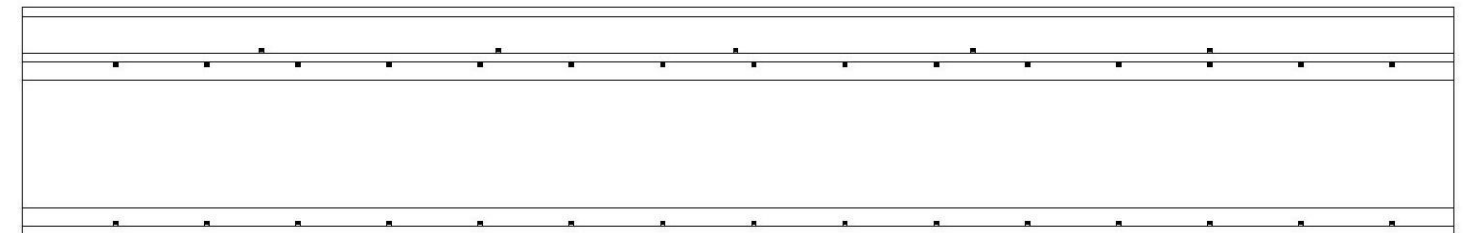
Disposición de las rejillas para el drenaje del tablero
